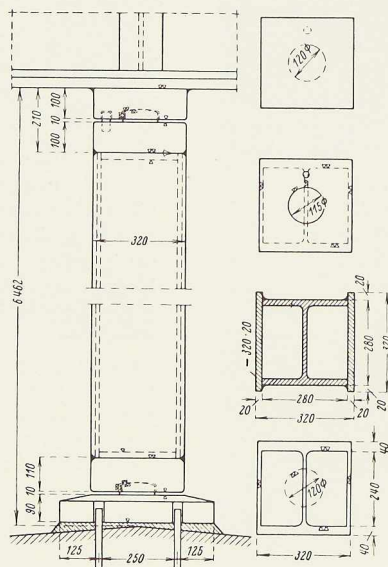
Appui pendulaire soudé constitué par une poutrelle à larges ailes.
